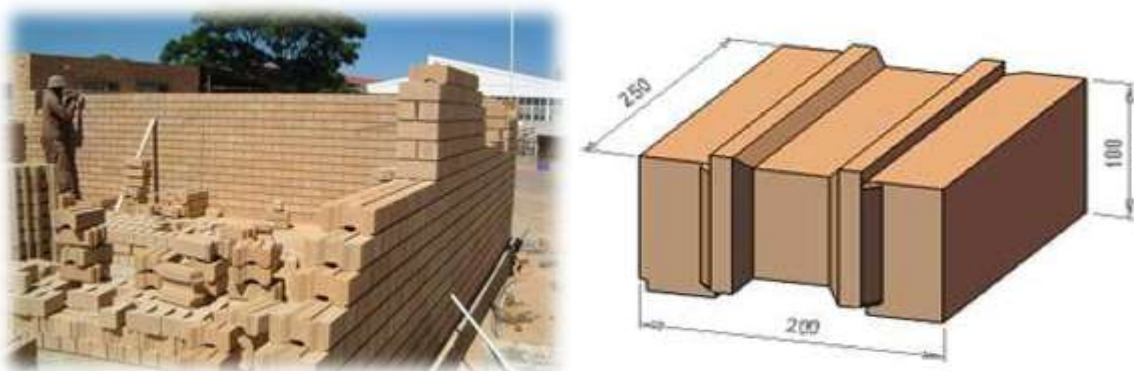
Sistema constructivo para muros: Solbric (Simion, 2009)
